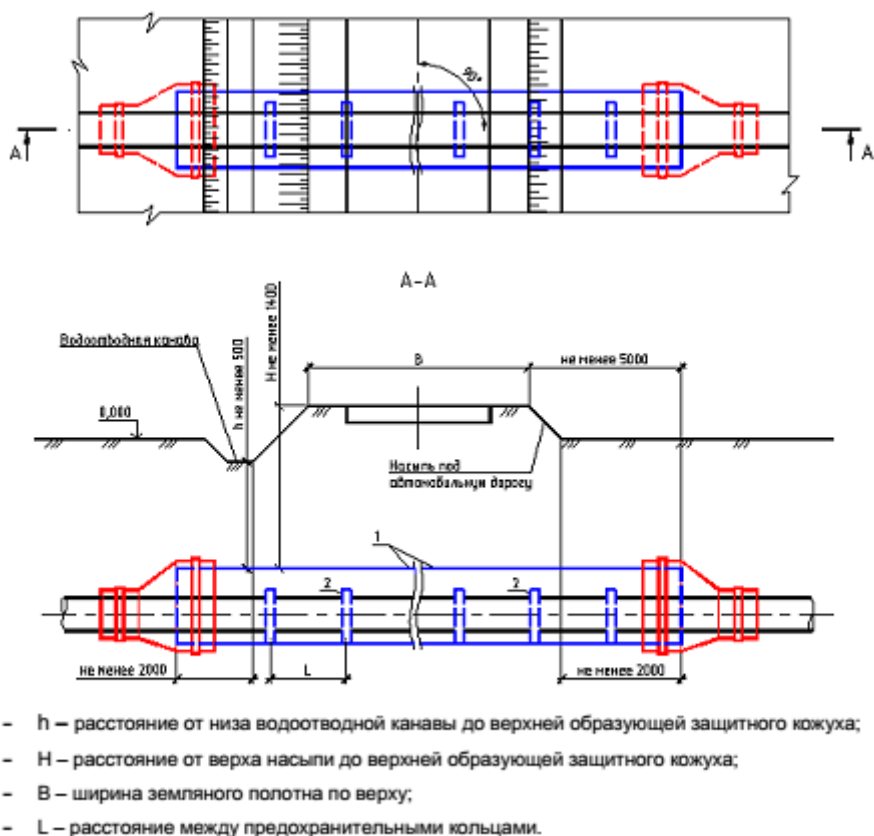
Схема укладки проектируемого трубопровода на переходе через автодорогу
